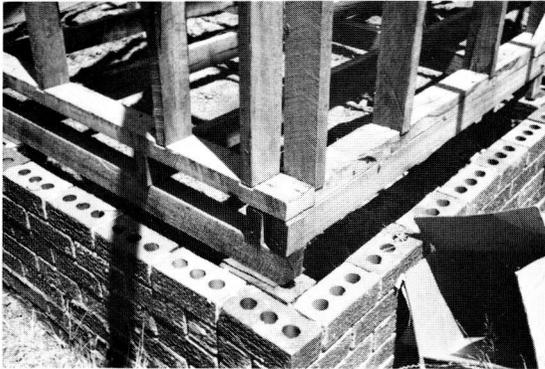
Brick veneer Constructionの枠組と外壁Brick (外壁Brickと枠組は独立しており、ワイヤーや薄い鉄板で部分的につながれている)
